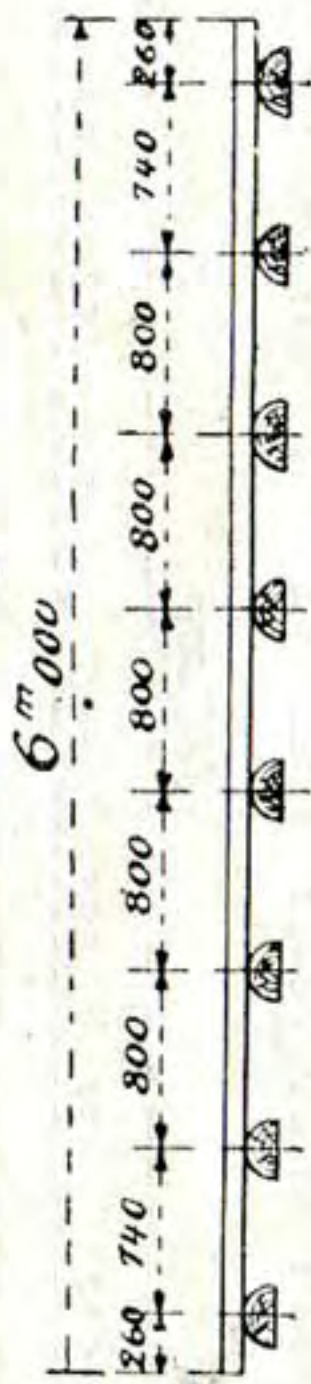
Spoor met rails van 6 m. lengte (*versterkte aanleg*).
